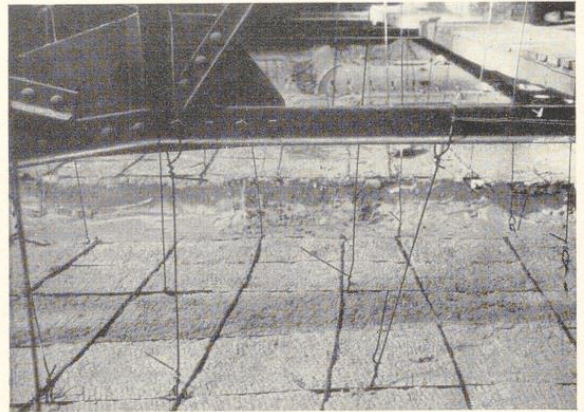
Abhängen einer Rabitzdecke an eiserner Dachkonstruktion
